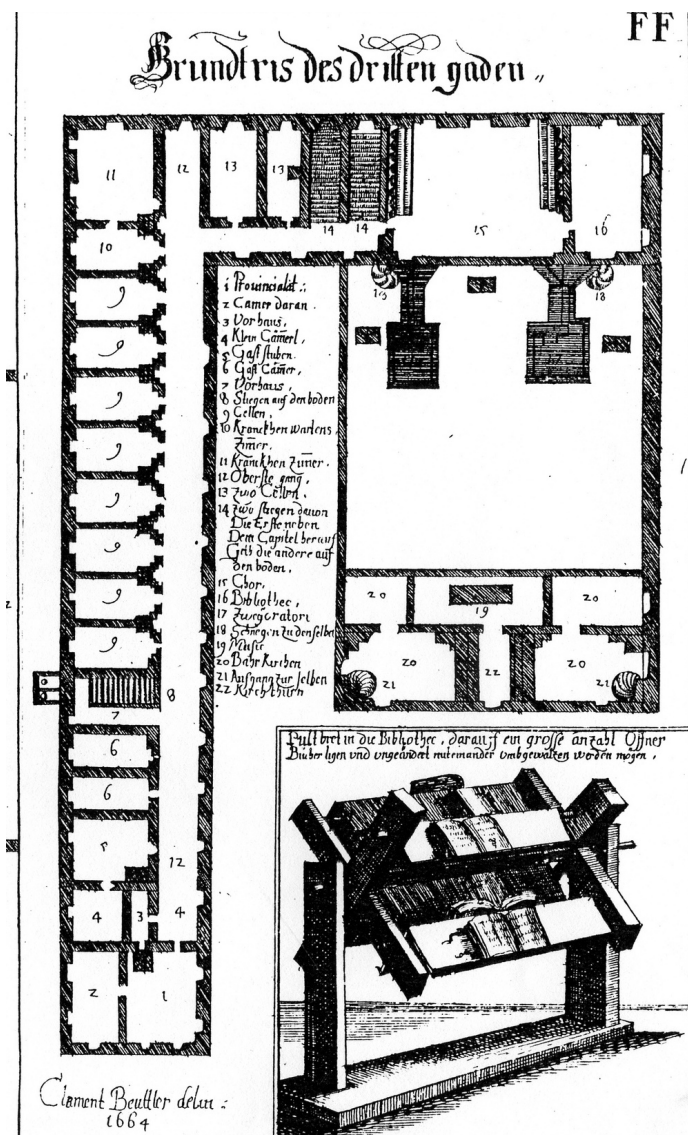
Topographia Windhagiana Aucta, Ausschnitt aus Stich FF, Grundriss des zweiten Obergeschoßes, bez. „Clemens Beuttler delin. 1664“ (Foto Herwig Friesinger)
